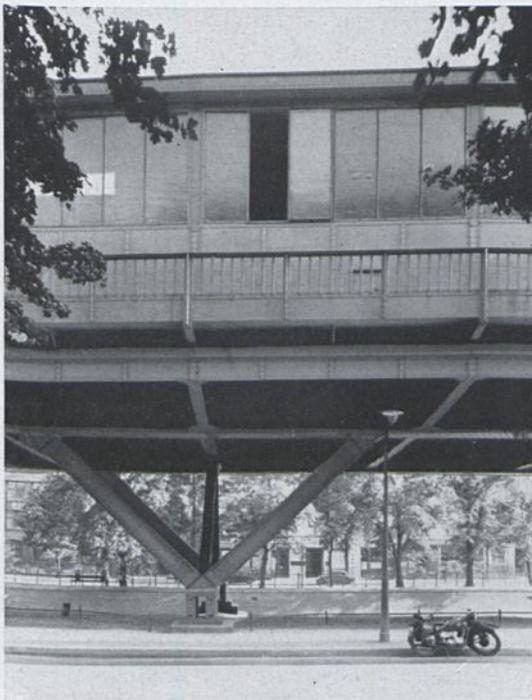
Ansicht der Halle mit den Spreizen (bewegliches Lager).
